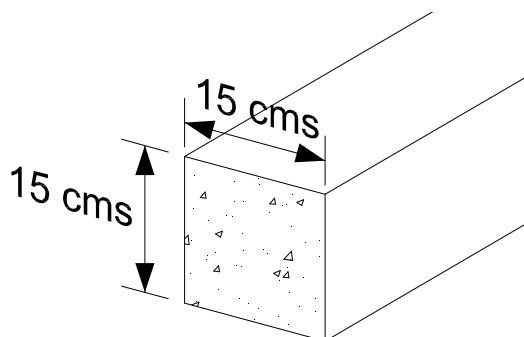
Medidas de Sardinel para Pavimento Rígido
